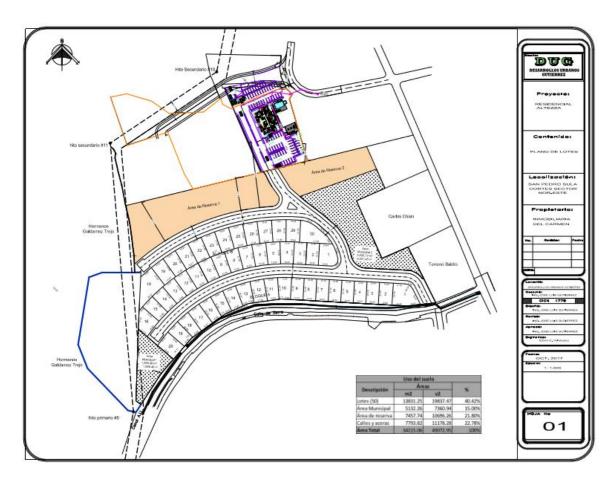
Diseño de lotificación Altezza (calles de 13 metros)
